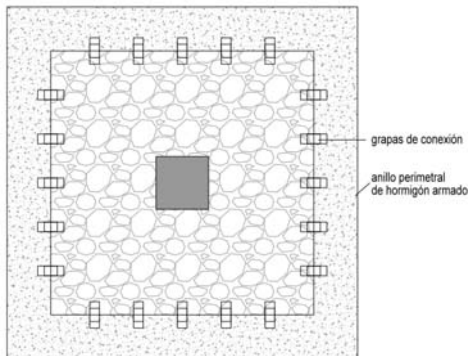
Planta de zapata aislada reforzada. Fuente propia.
